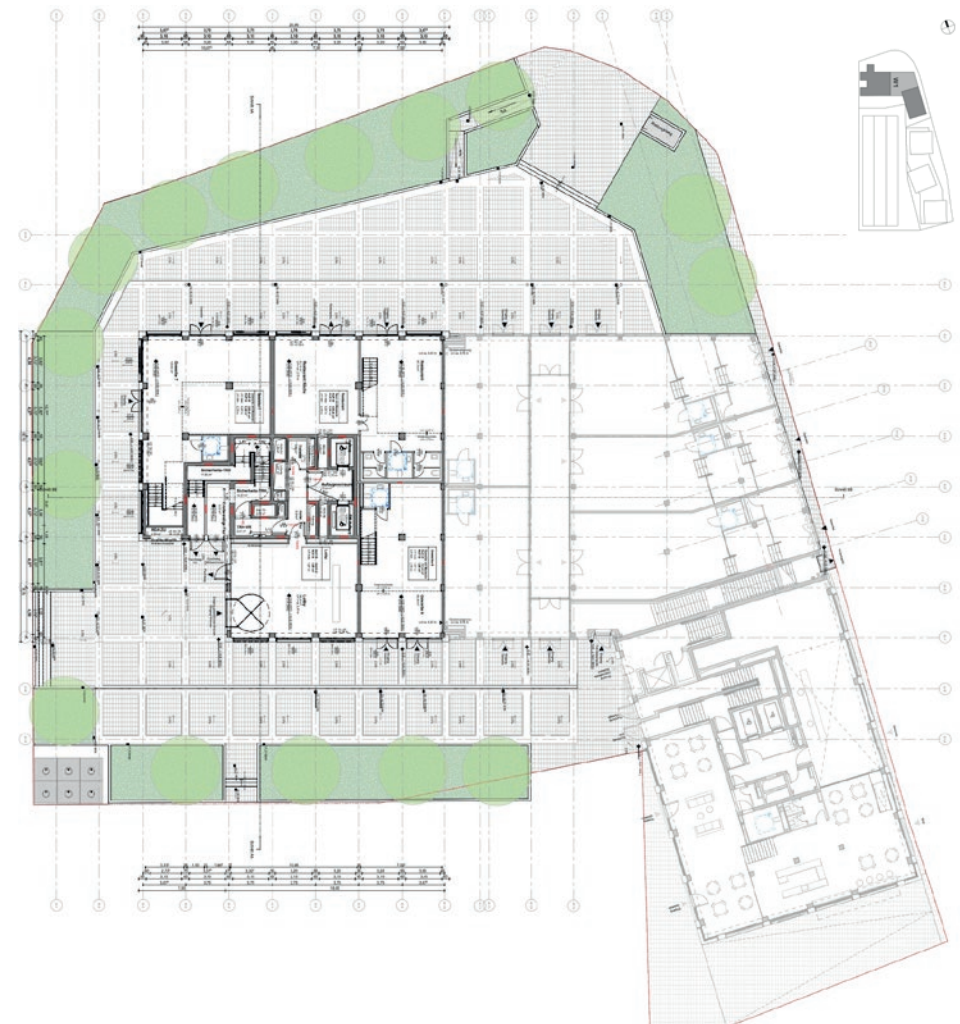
Grundriss EG Neubau Turm mit Beherbergungsstätte und Gewerbeflächen, Baufeld A - W1 (MVRDV, Stand 27.05.2022)
